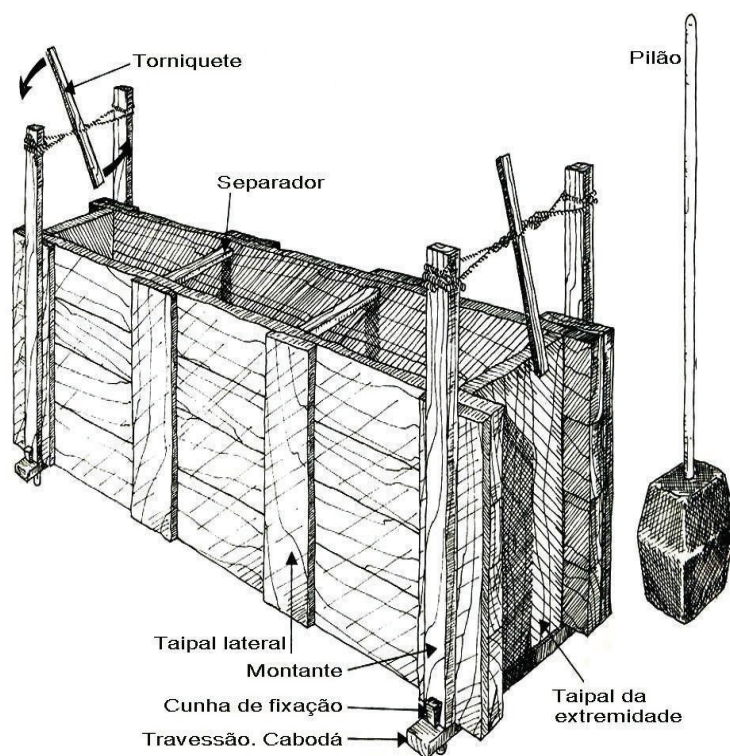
Equipamento usado para a construção em taipa de pilão (Bardou, 1981)
